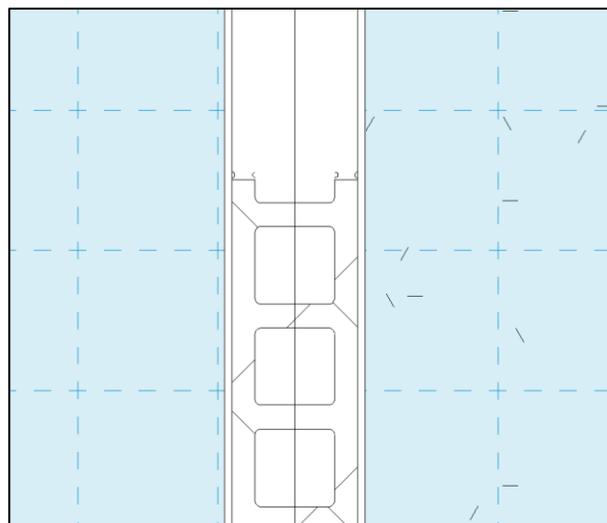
Componente de detalle que imita el patrón superior de un bloque
